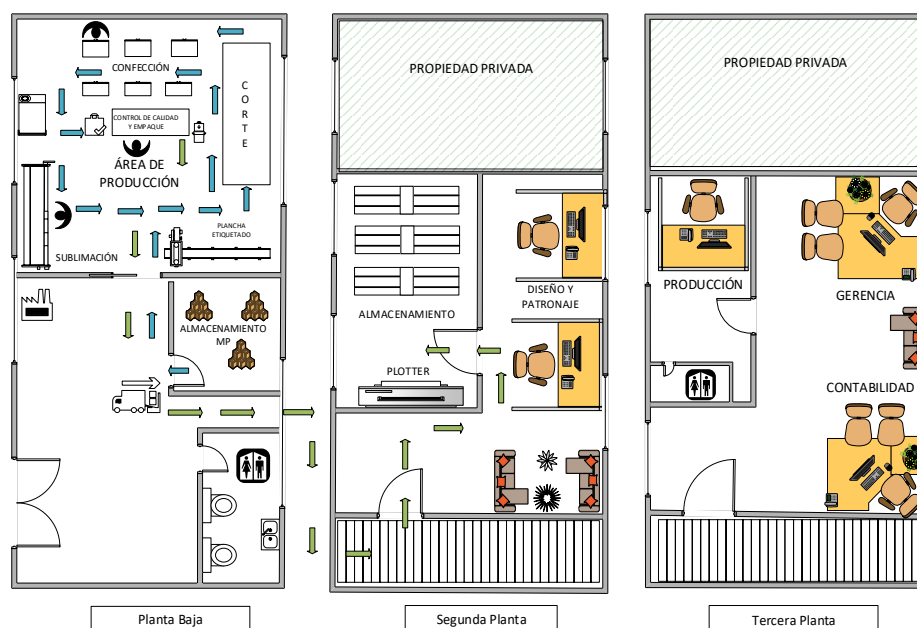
Diagrama en planta de la manufactura textil en Imbabura.
